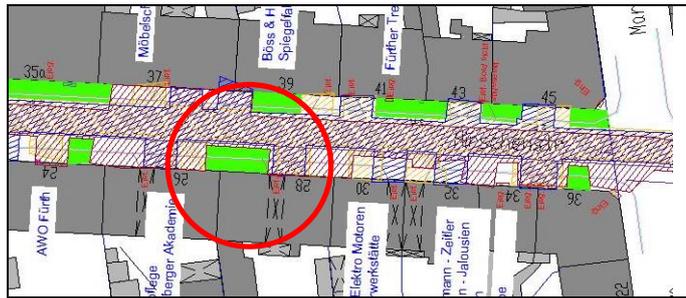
Ausschnitt Pufferplan (2,50 m)
